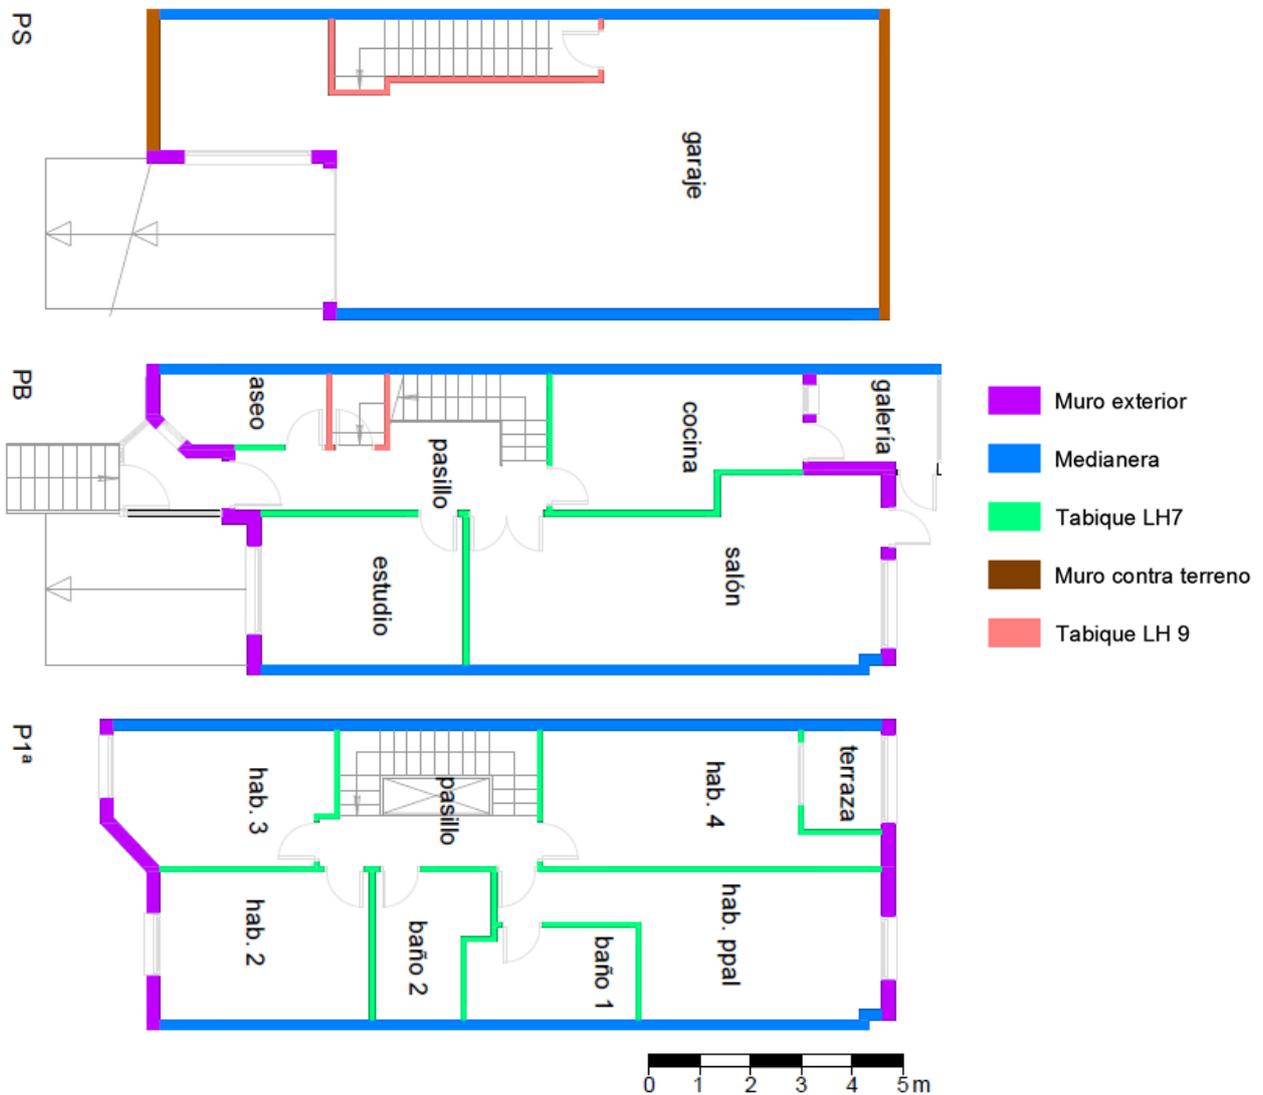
Plantas con elementos constructivos vivienda unifamiliar Albacete.
